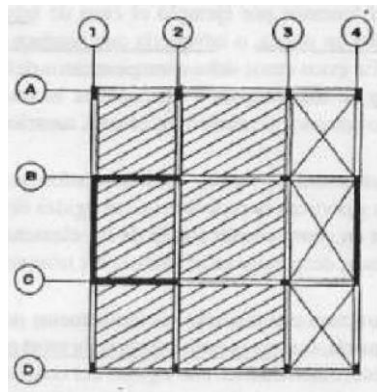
Planta de edificio con aparente simetría, pero que al tener abertura en la zona derecha no podrá transferir la fuerza sísmica hacia el eje 4.
